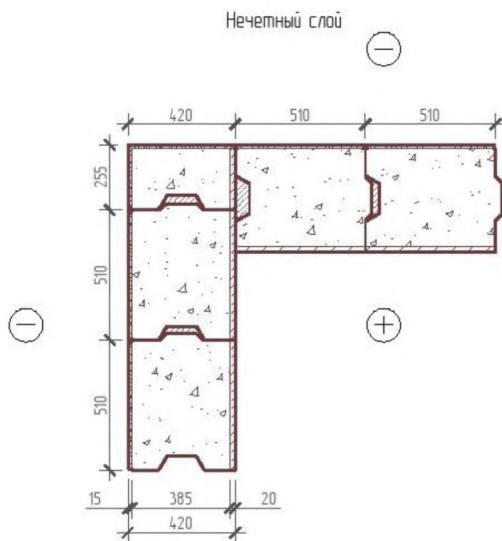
Кладка наружных углов стен из керамзитобетонных блоков
